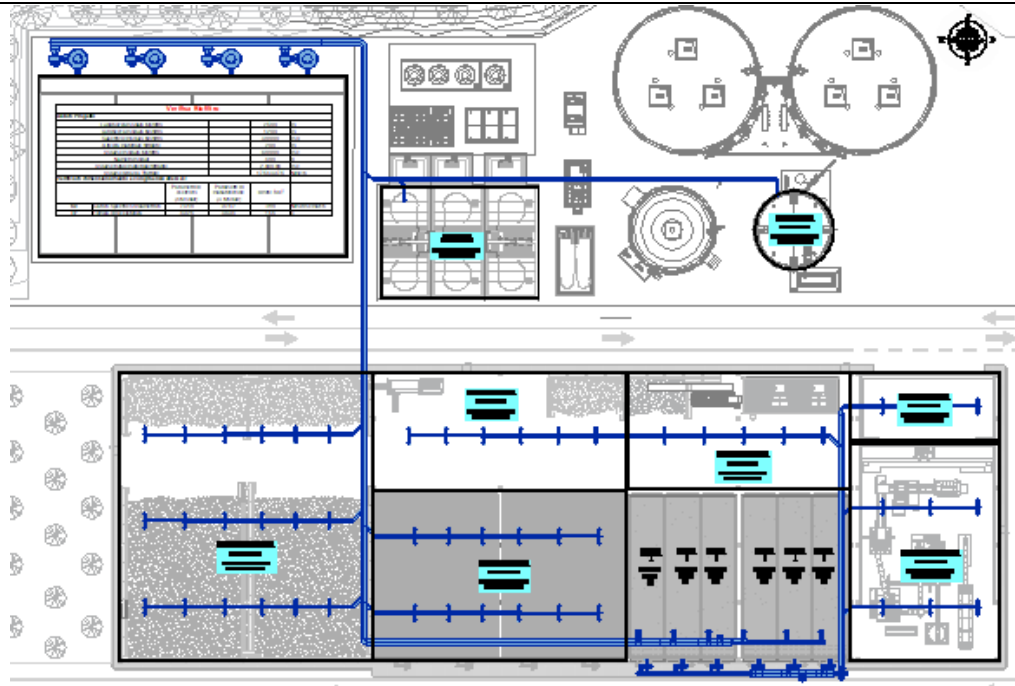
ESE.EGR.AIR.001 – Planimetria dimensionamento rete aria
